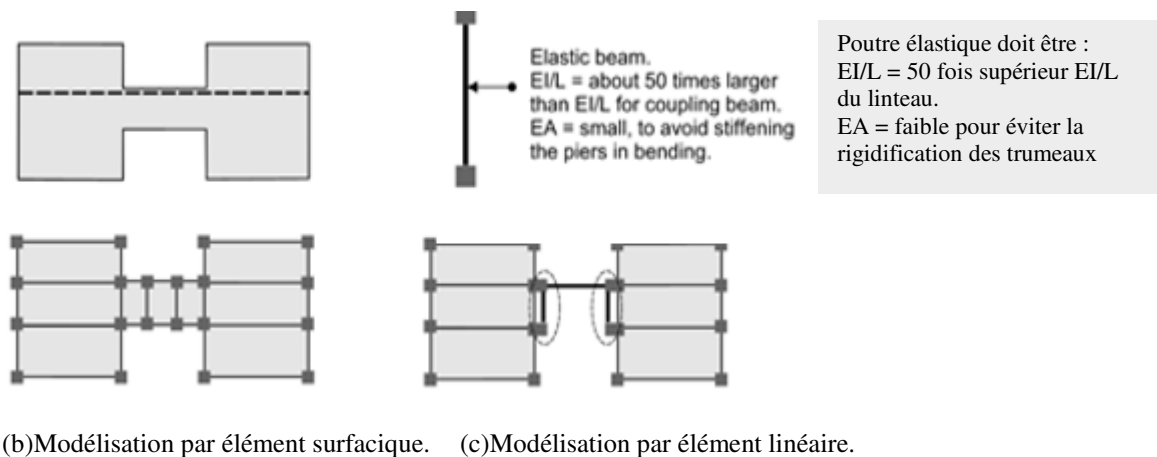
Poutre-linteau modérément profonde « niveau dalle encré au sommet du linteau ».
